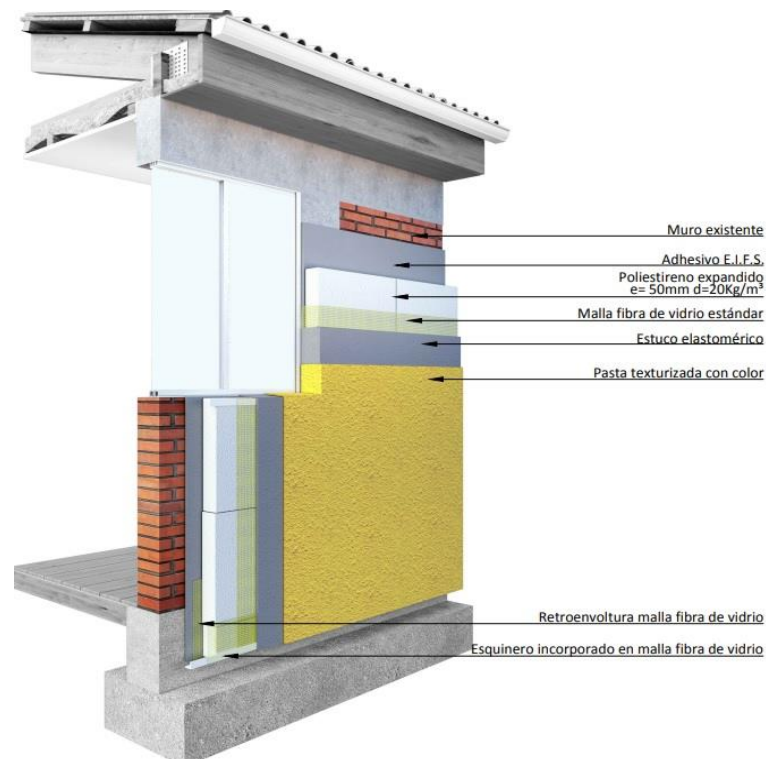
Solución constructiva para muro de casa aislada y pareada en comuna Concepción. Fuente [8].
